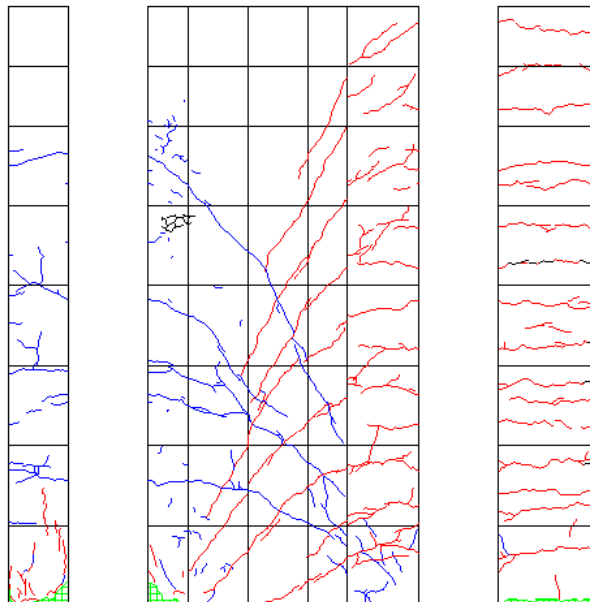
R=1/33 ひび割れ図
